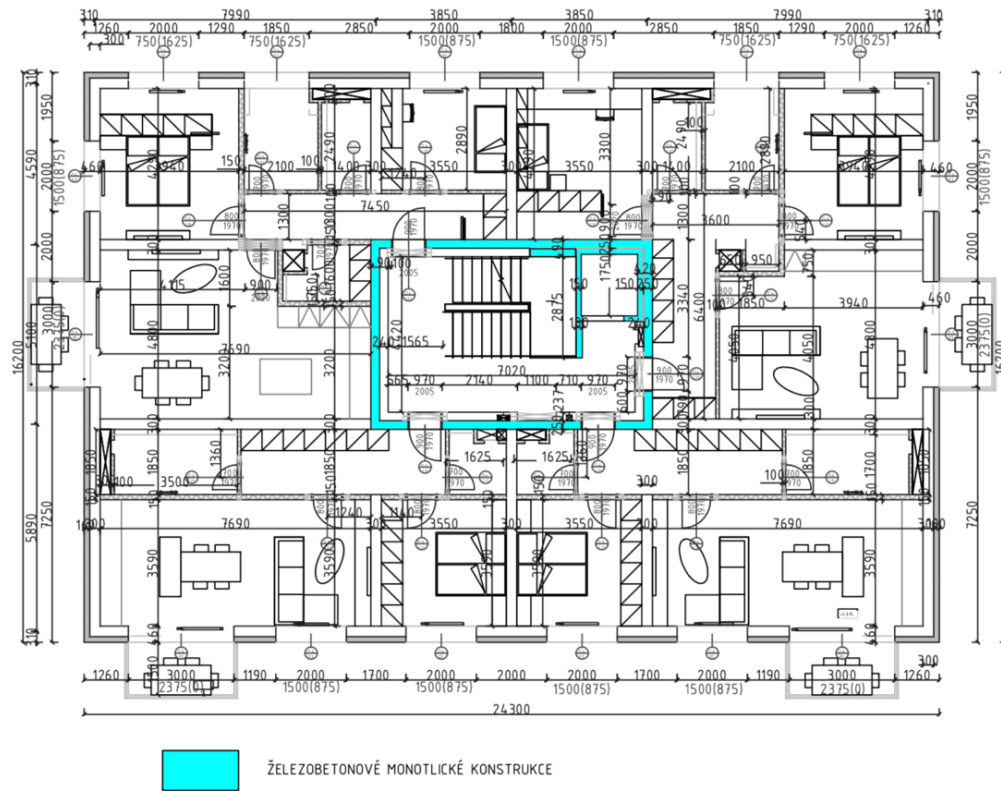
Železobetonové monolitické konstrukce, 1.NP
